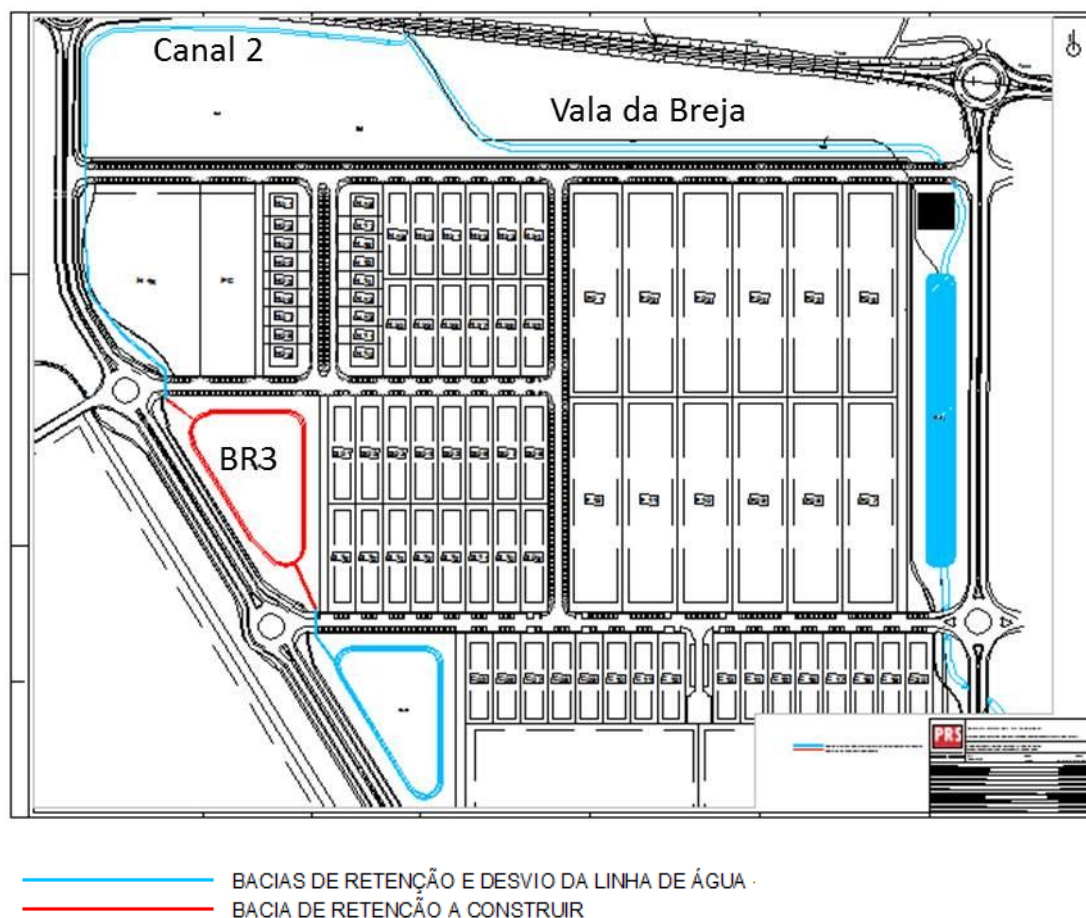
Planta Geral – Bacia de retenção BR3 e Canal 2.
